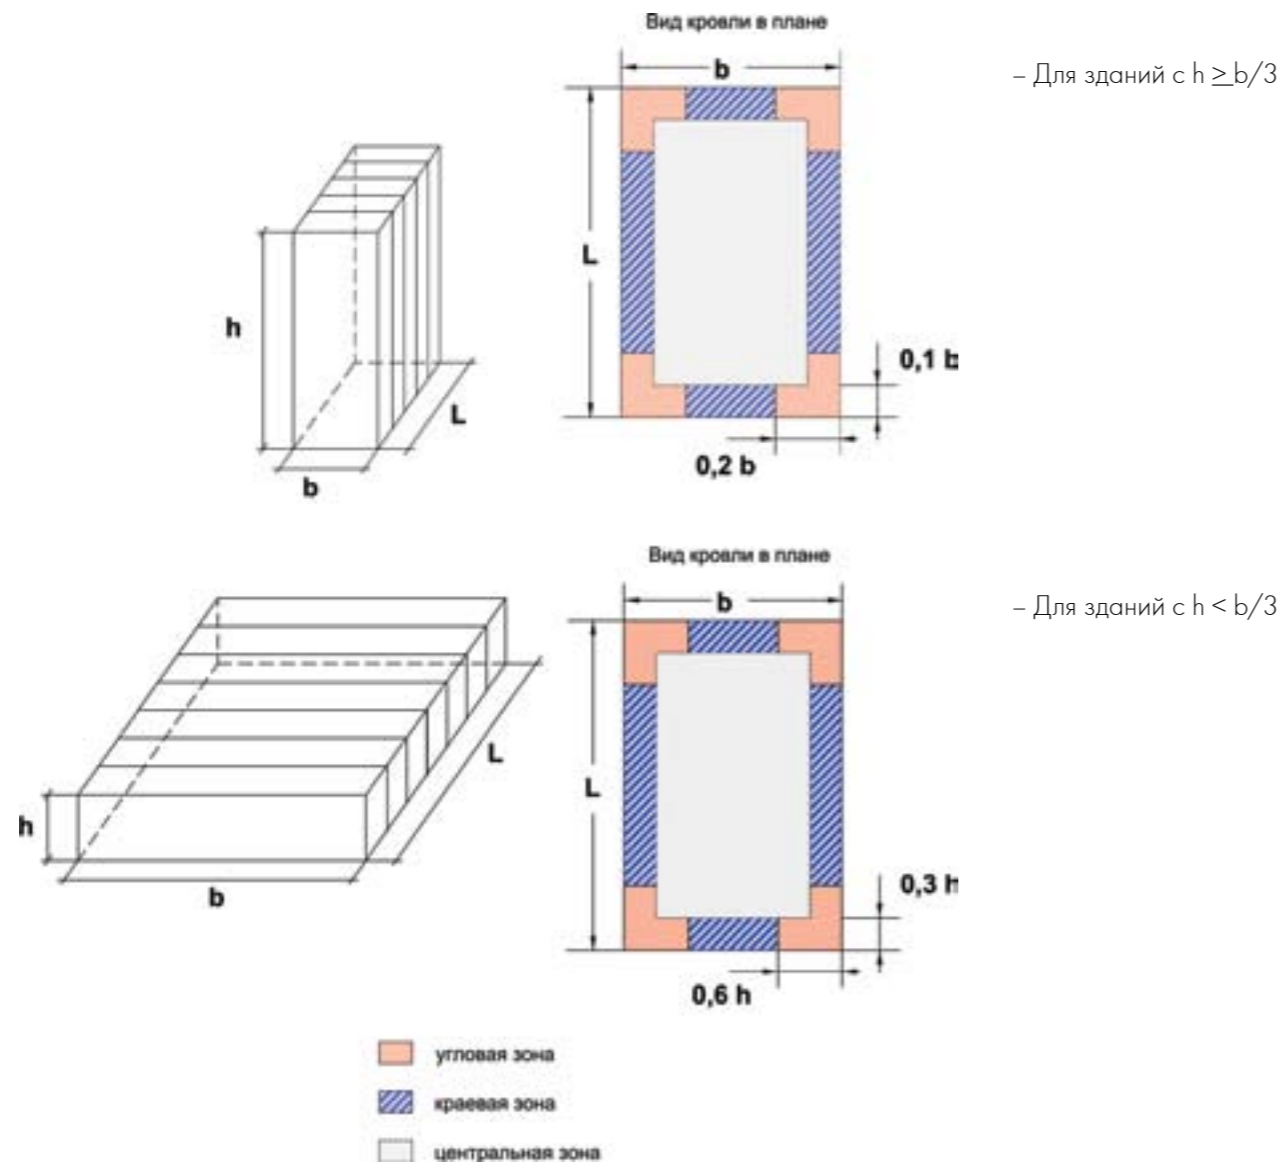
Деление кровли на зоны ветровой нагрузки.
